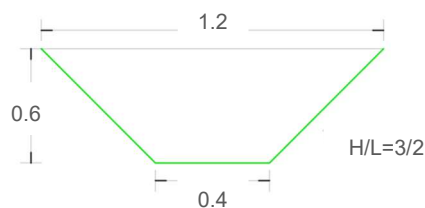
Sezione tipo canaletta di raccolta acque piovane
